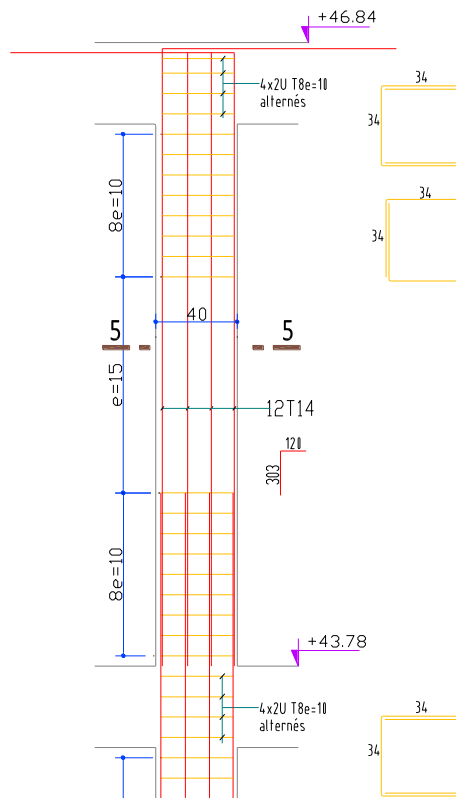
Coupe verticale de ferrailage des poteaux $40 \times 40 \text{ cm}^2$.
